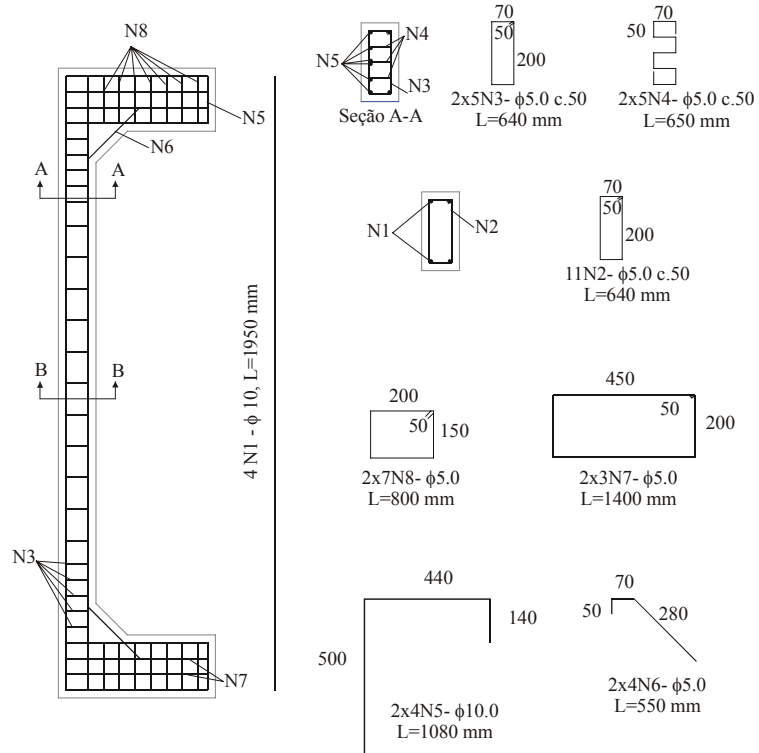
Detalhamento de armaduras do grupo PCA4
